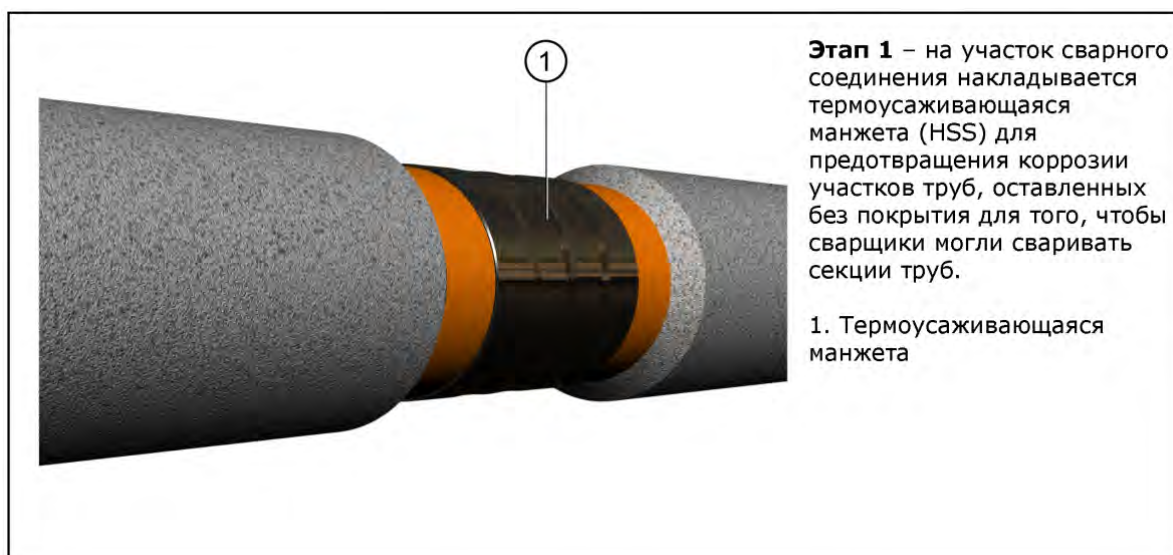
Схематическое представление стыков свариваемых труб.
